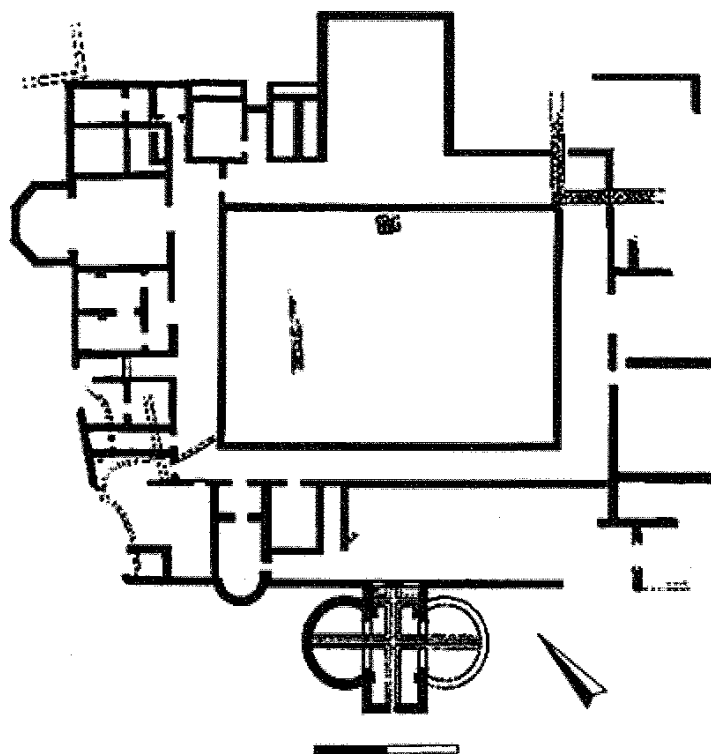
Planimetría de la *villa* de Aguilafuente (Segovia).
